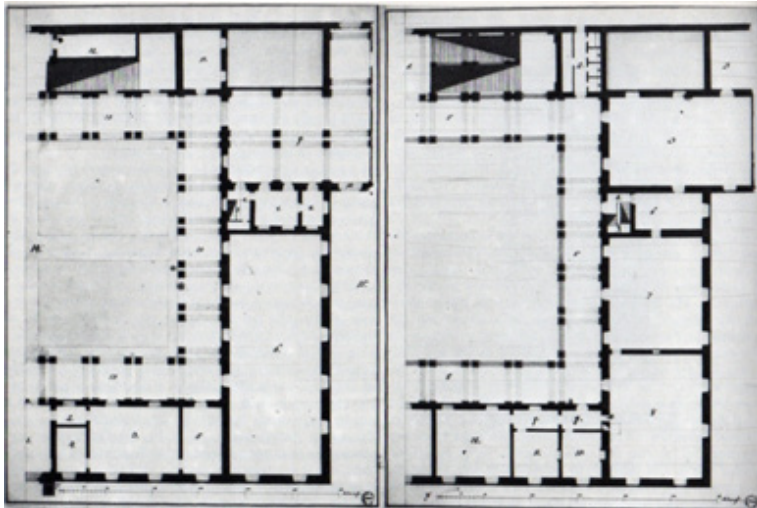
L. Pollack, "Progetto di sistemazione, secondo i piani di Piermarini, del pian terreno e del primo piano della nuova ala di Brera", 1784. Milano, Archivio di Stato
